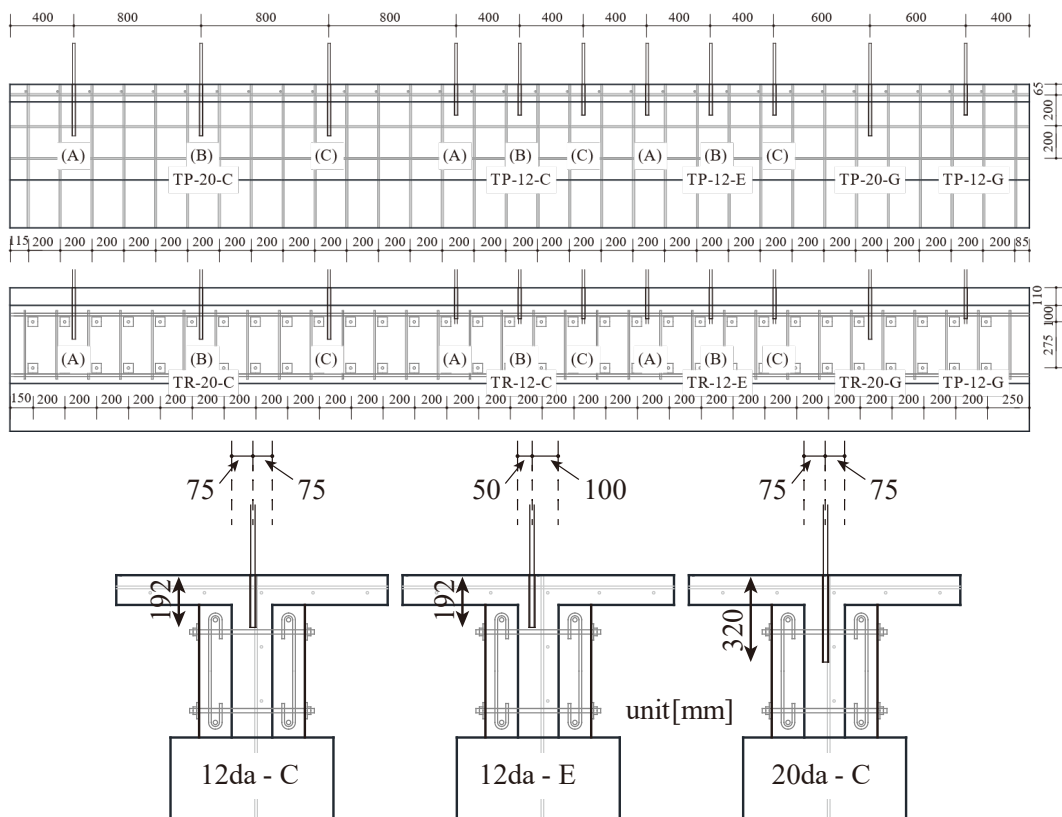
T 型試験体 あと施工アンカー設置位置図
